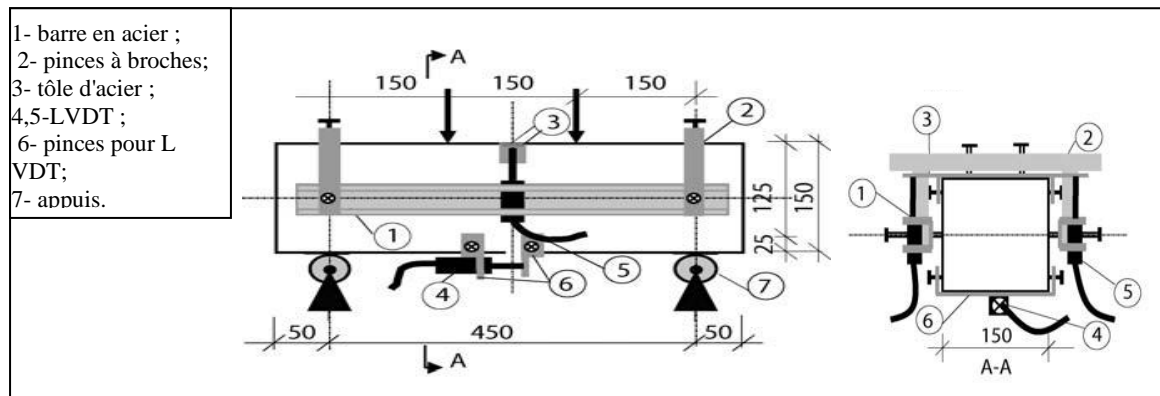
le spécimen de la poutre de Tlemat (2006) , les dimensions en mm.
